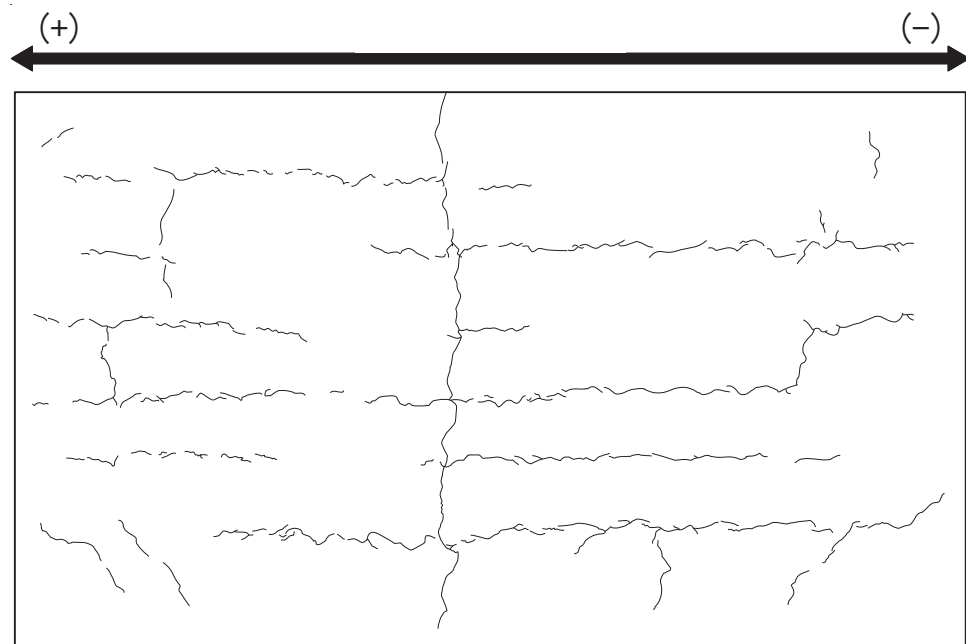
(1) 乾燥試験体 [1] 実験前ひび割れ状況
